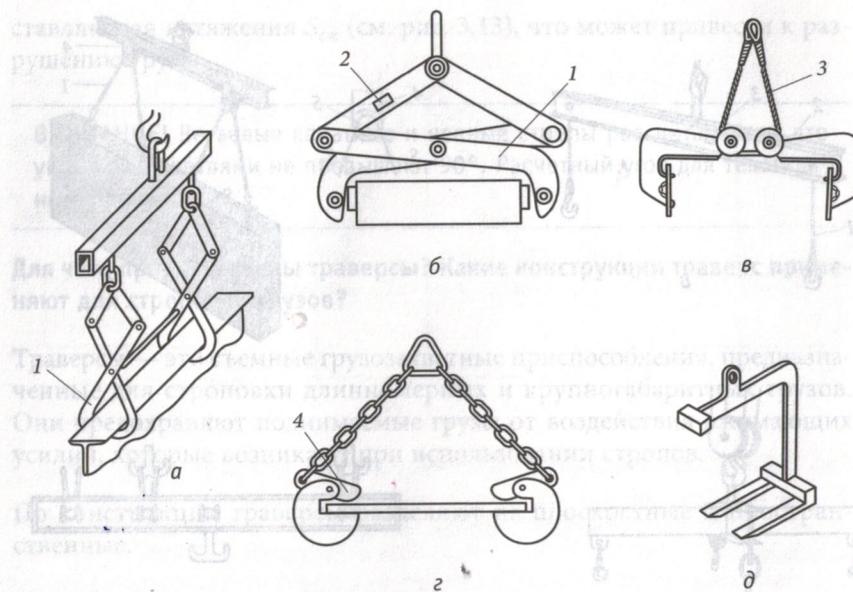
Захваты: а — клемевые рычажные на траверсе; б — фрикционный рычажный; в — фрикционный рычажно-канатный; г — эксцентриковый; д — вилочный; 1 — рычаг; 2 — клемма; 3 — канат; 4 — эксцентрик
